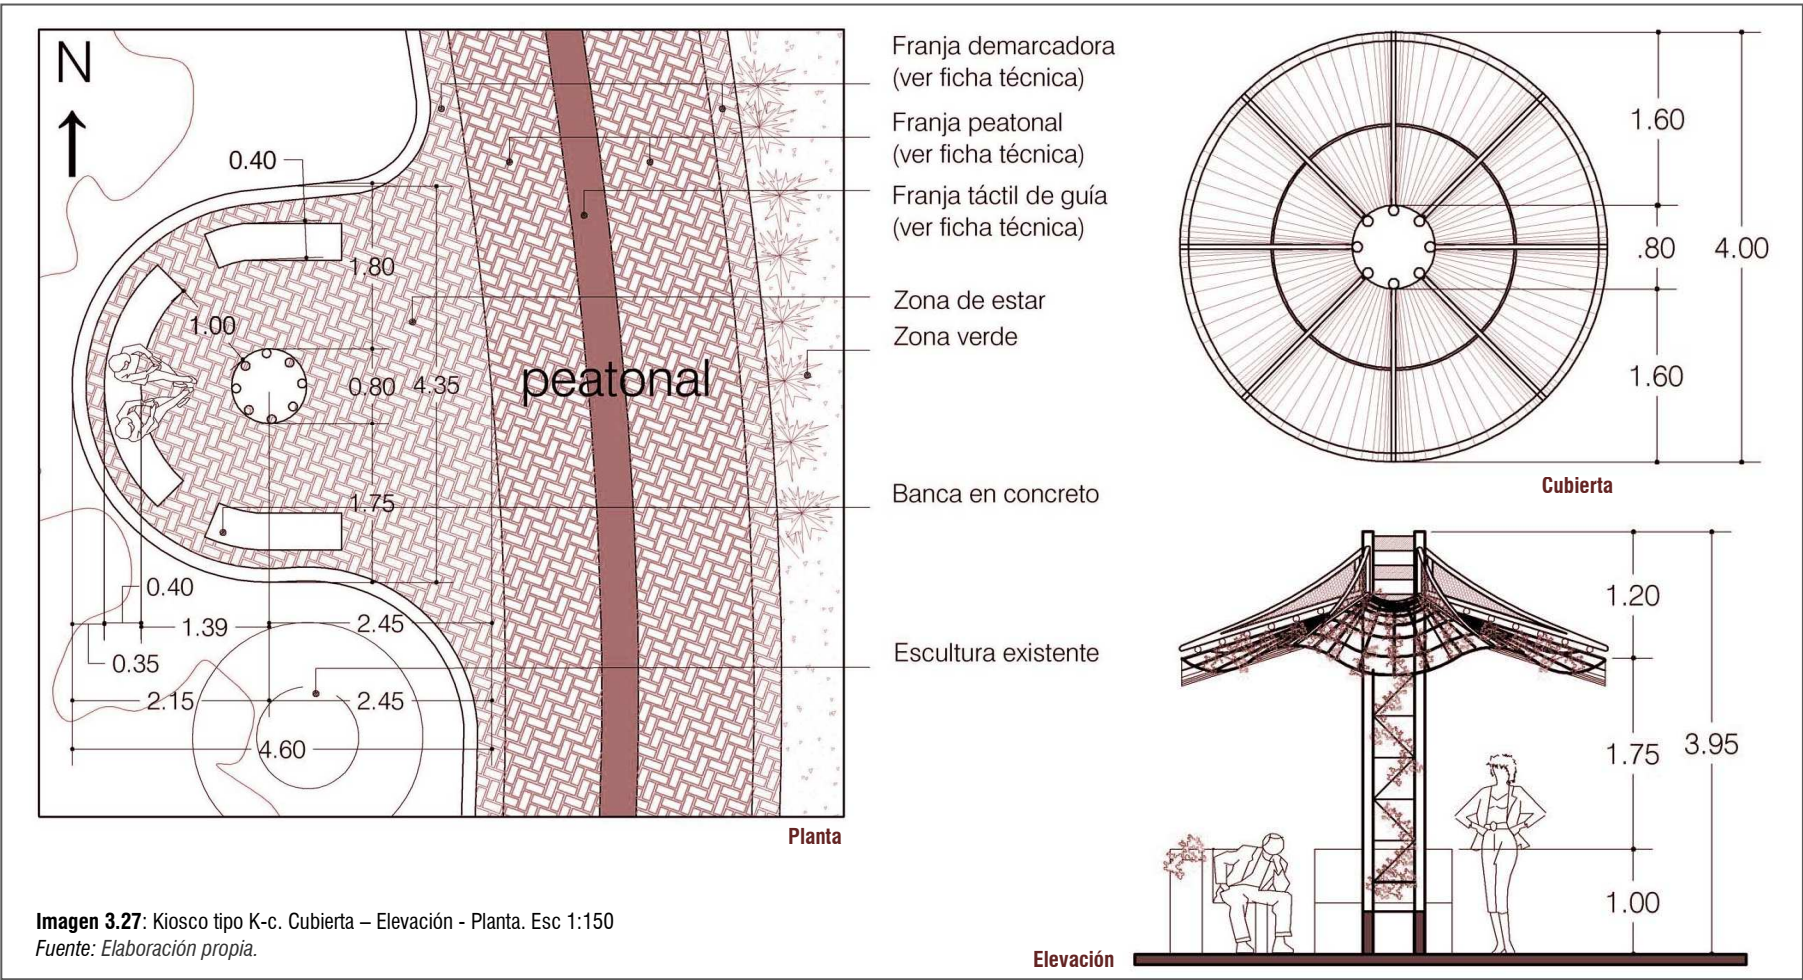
Kiosco tipo K-c. Cubierta – Elevación - Planta. Esc 1:150
